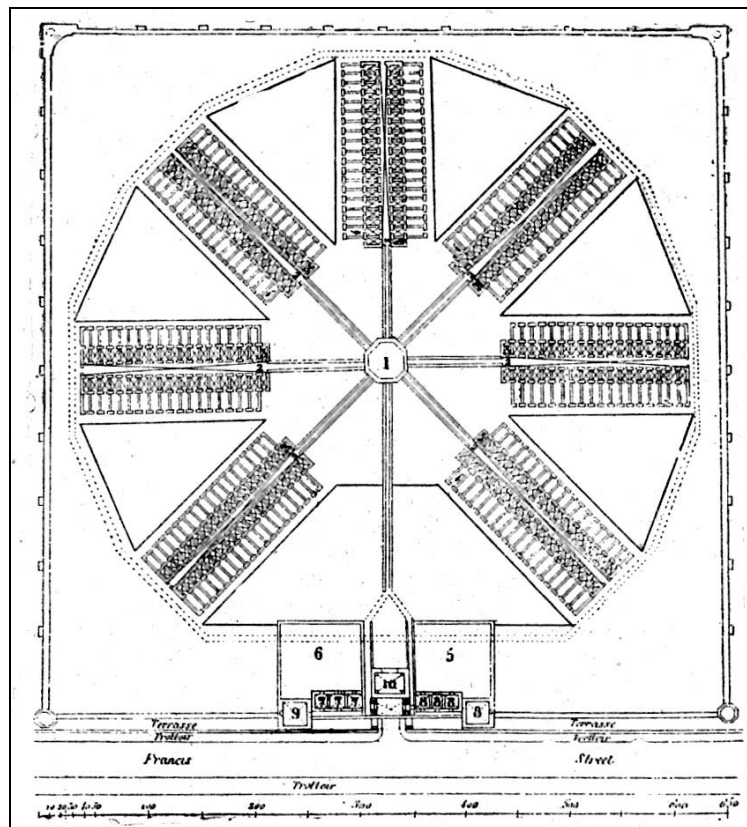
PLANO DEL PROYECTO ORIGINAL DE HAVILAND PARA LA PENITENCIARÍA DEL ESTE.⁴
